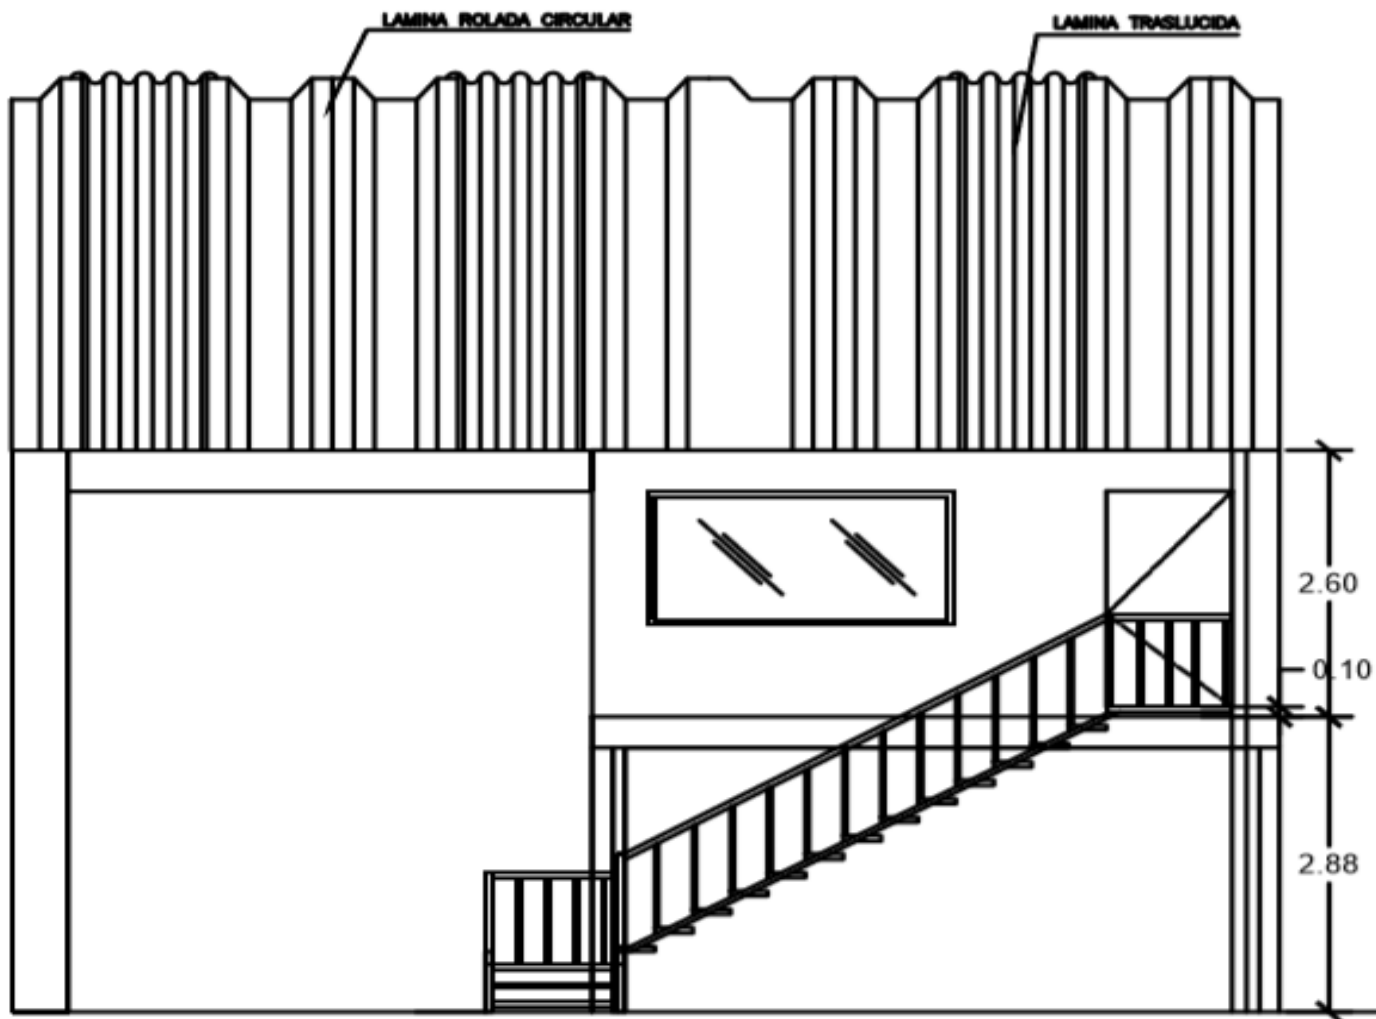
(C) Plano de la vista frontal del inmueble para la instalación de la planta de biodiésel
